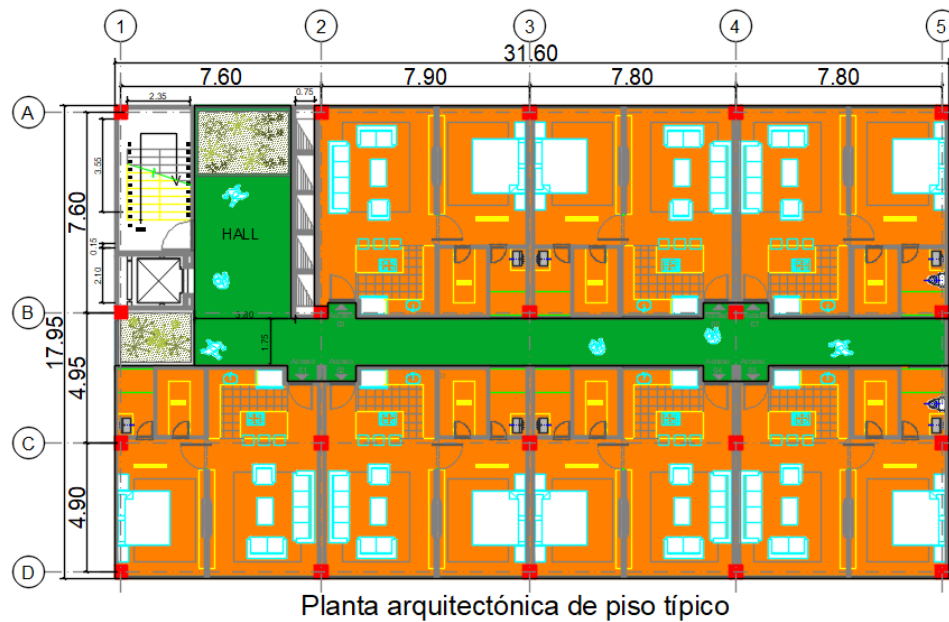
Planta arquitectónica de piso típico de la estructura analizada. (Vides. V. F., 2023).
